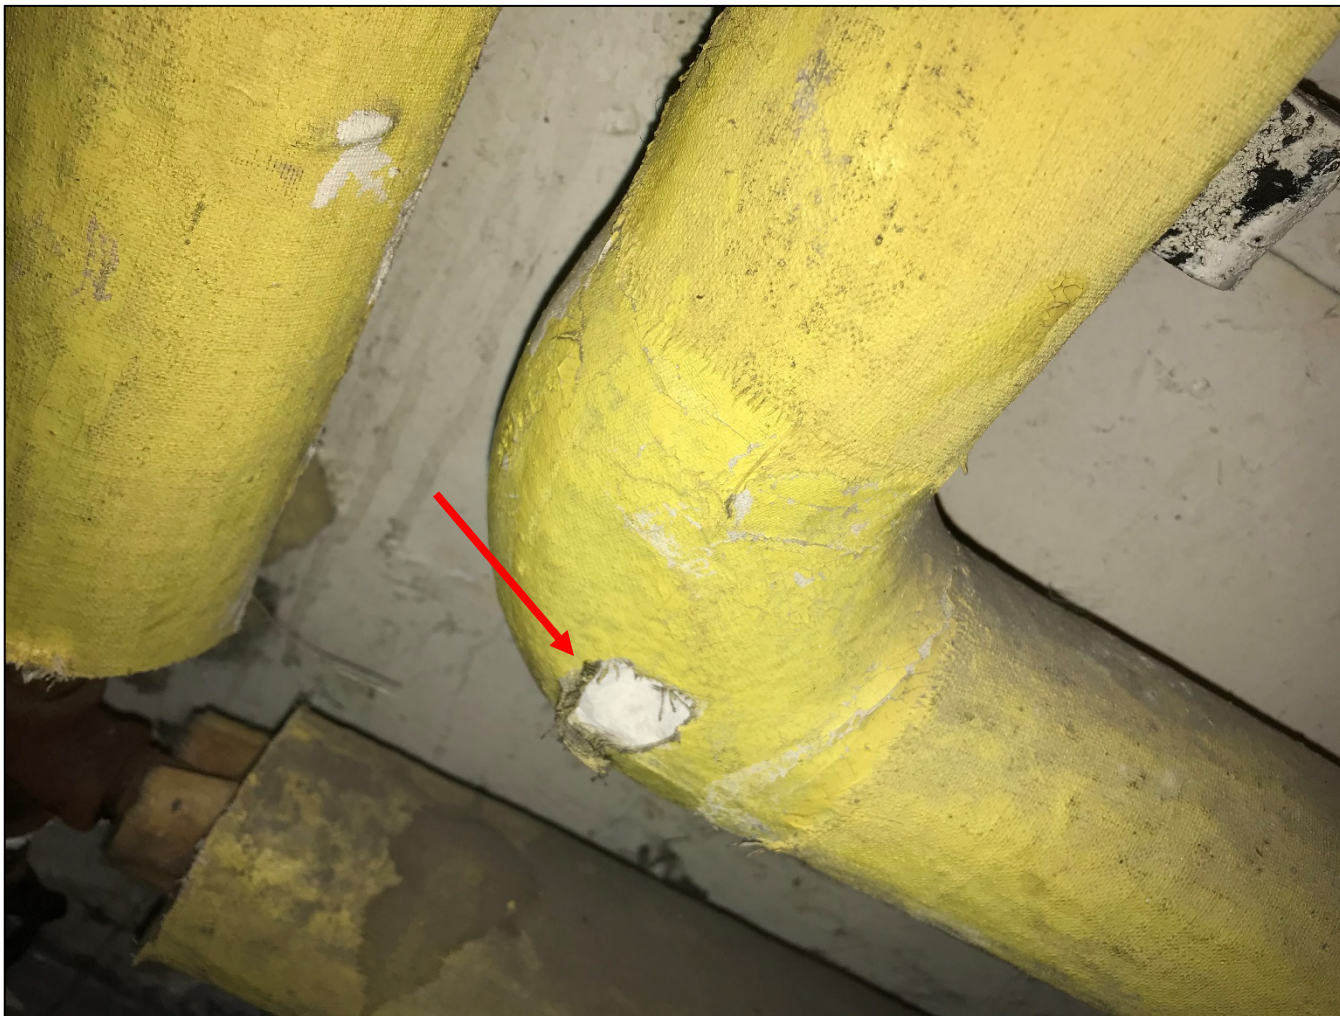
Vue de l'isolation blanche exposée des tuyaux de la salle 110
